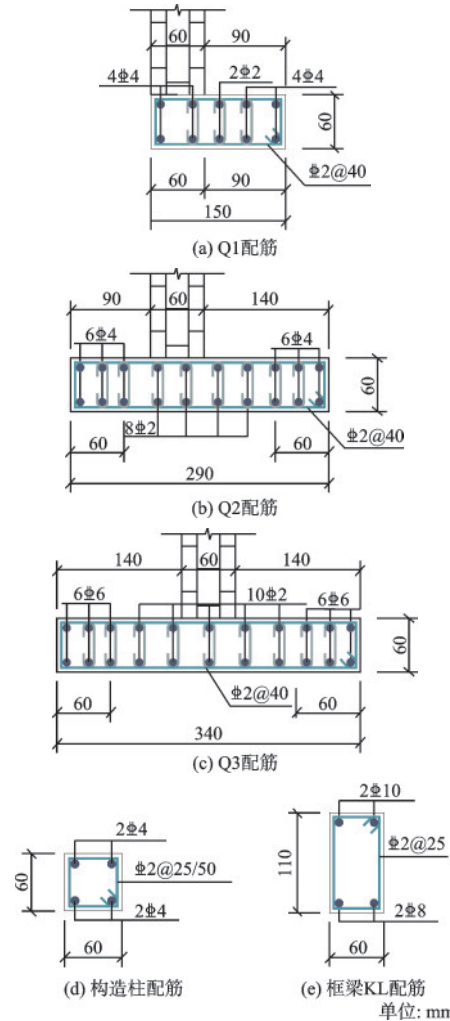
钢筋混凝土加强墙、构造柱及框架梁配筋
